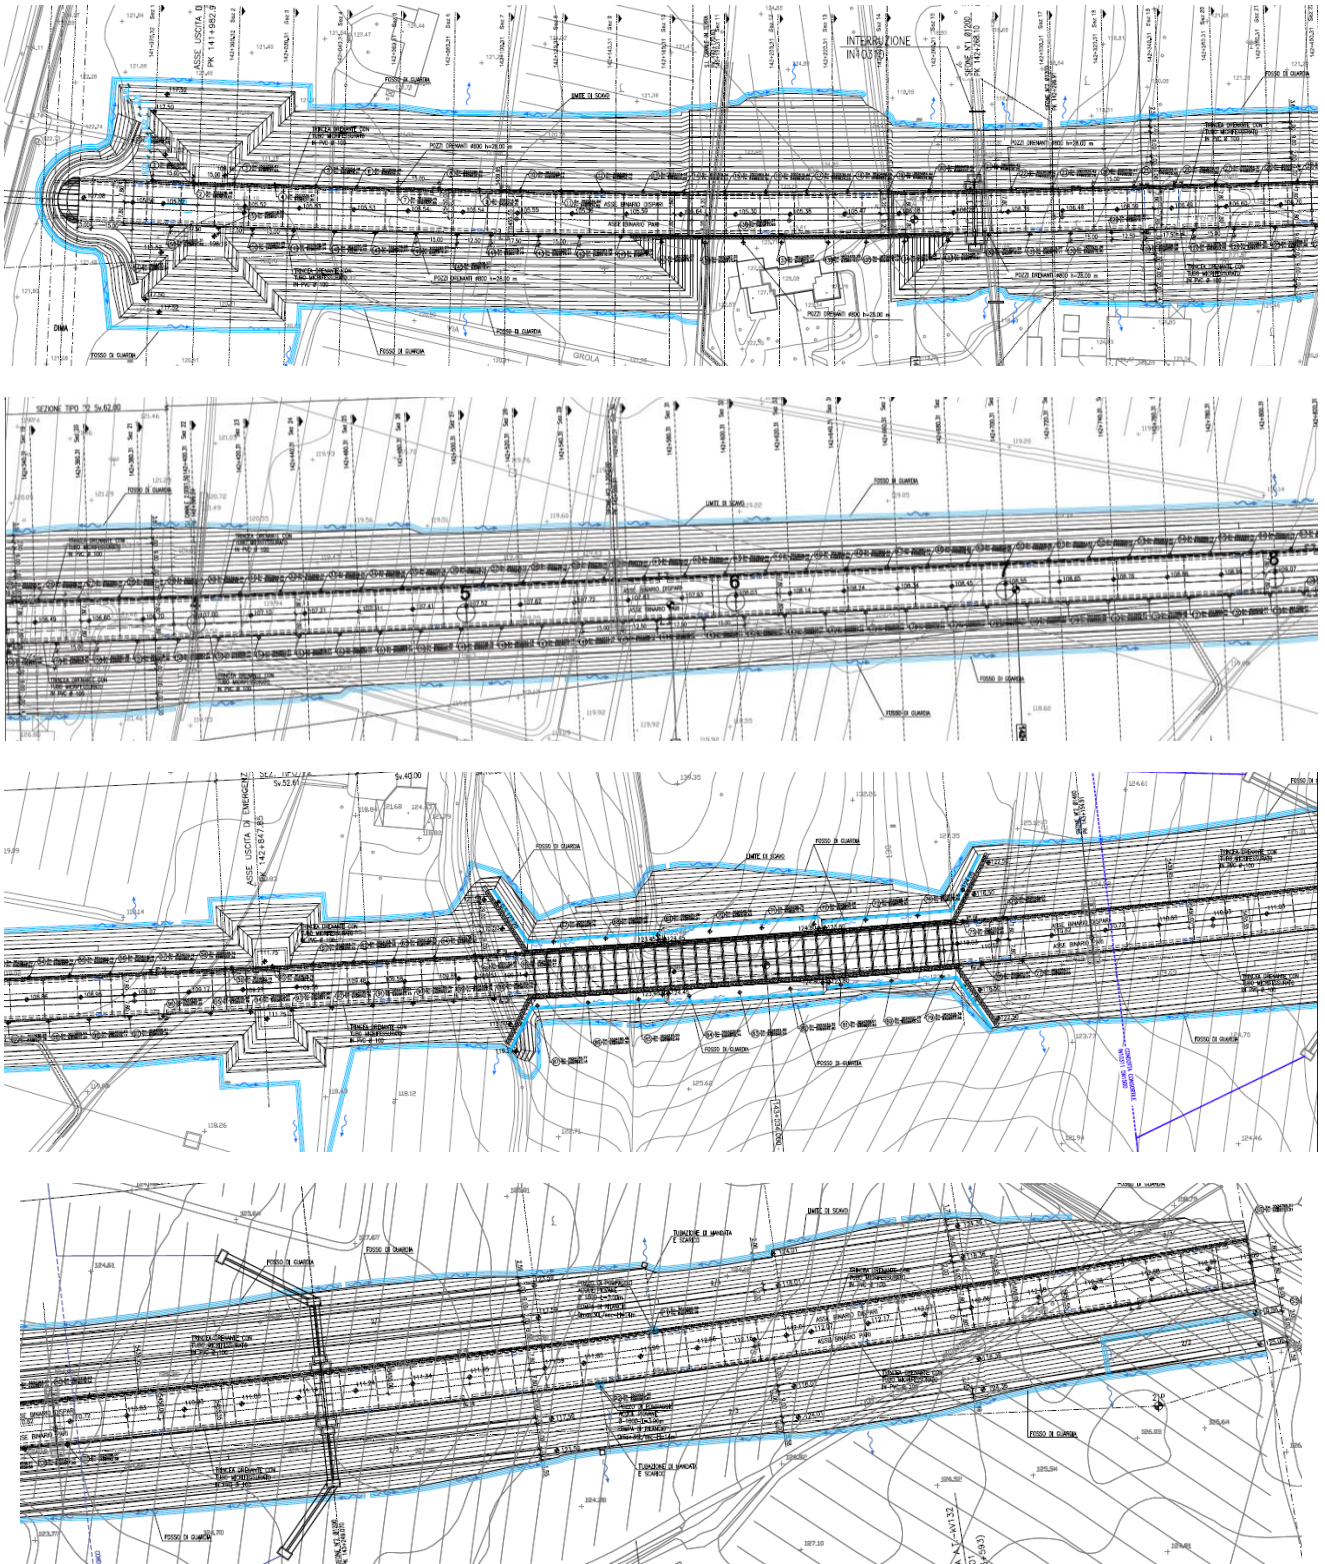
Planimetria di scavo galleria artificiale San Giorgio est.
